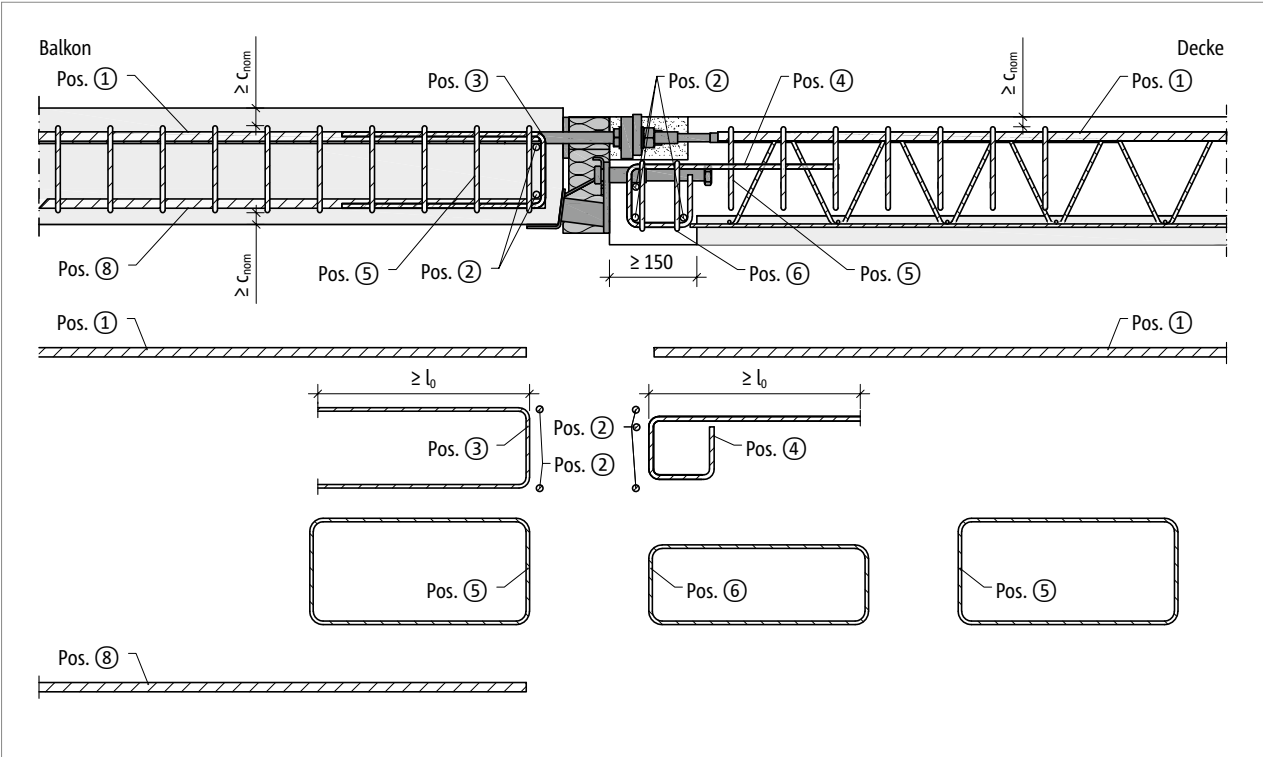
Schöck Isokorb® IQ Typ K-A: Bauseitige Bewehrung mit Gitterträger
